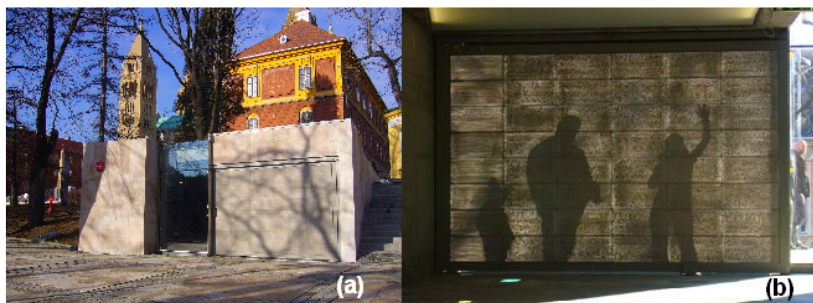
Portão de uma garagem com concreto translúcido. (a) Vista exterior; (b) vista interior.
